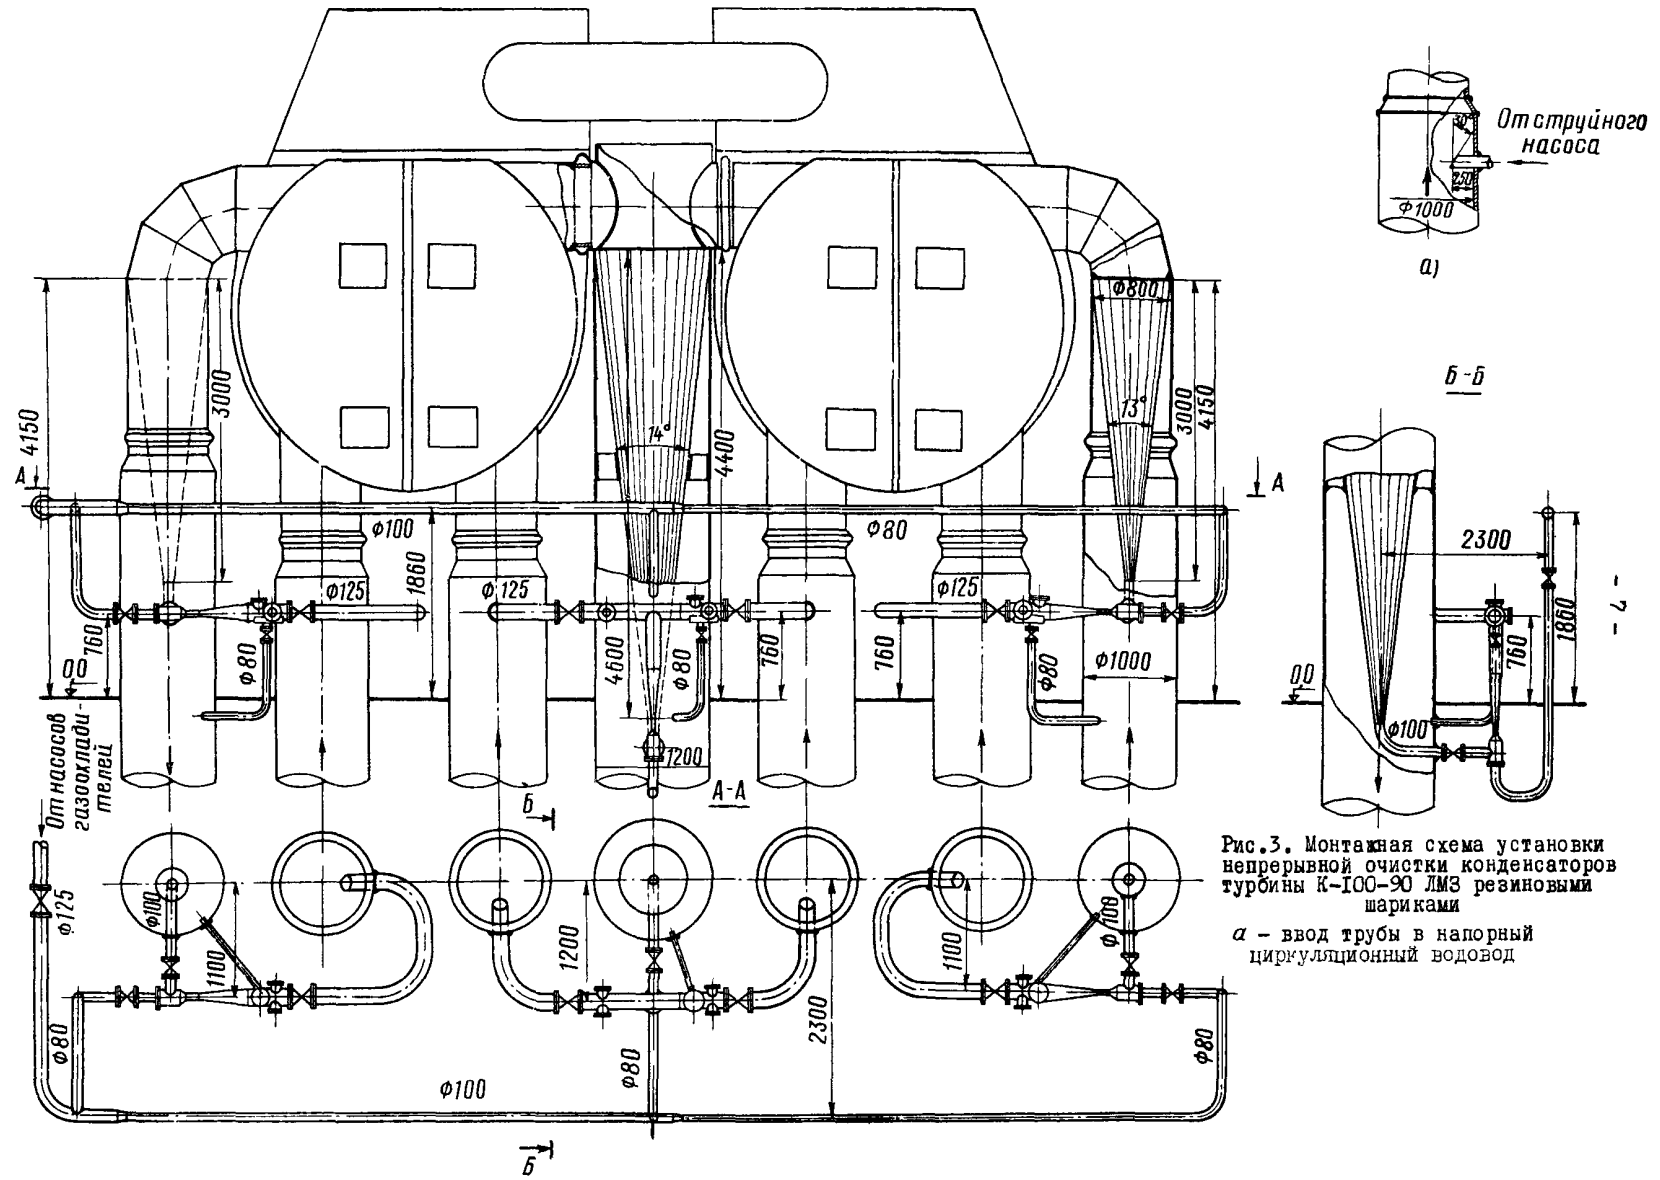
Монтажная схема установки непрерывной очистки конденсаторов турбины К-100-90 ЛМЗ резиновыми шариками
